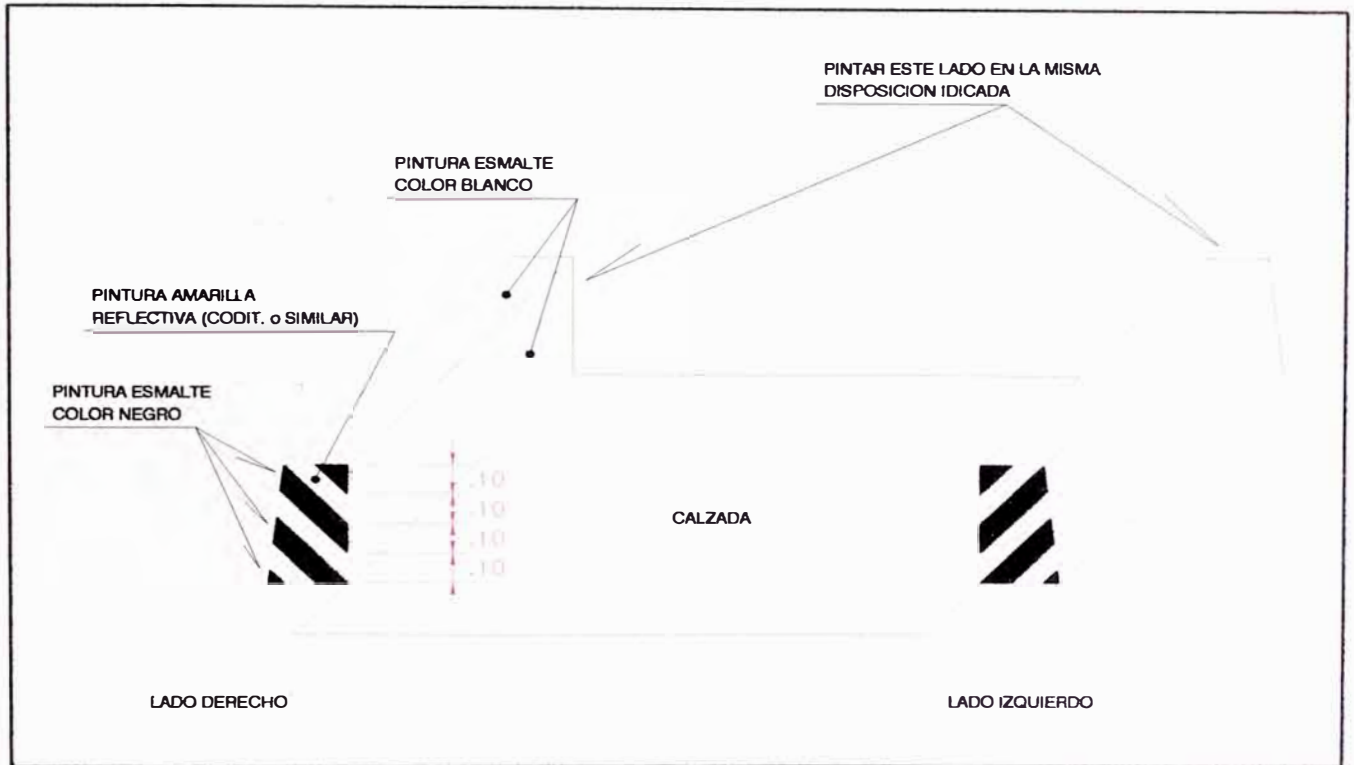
Pintado de Parapetos de Alcantarillas
